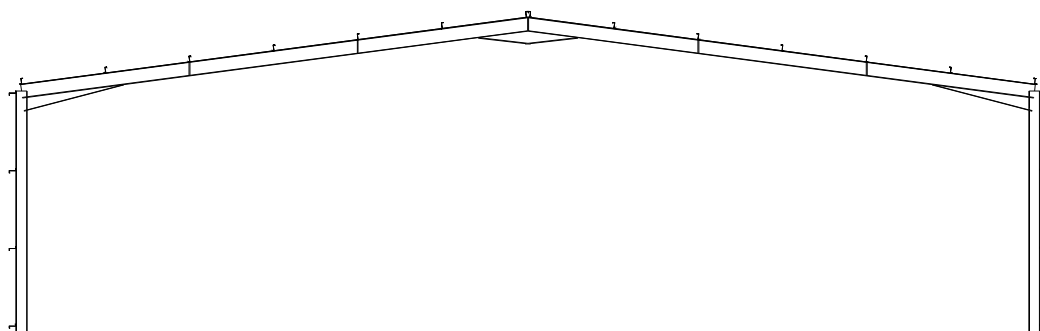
Pórtico de pavilhão industrial, pórtico rígido, perfil de alma cheia, recurso a esquadros
